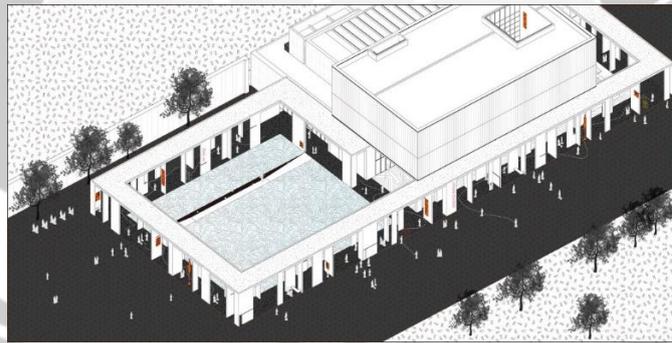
4 Site Plan Tian Han Cultural Park
